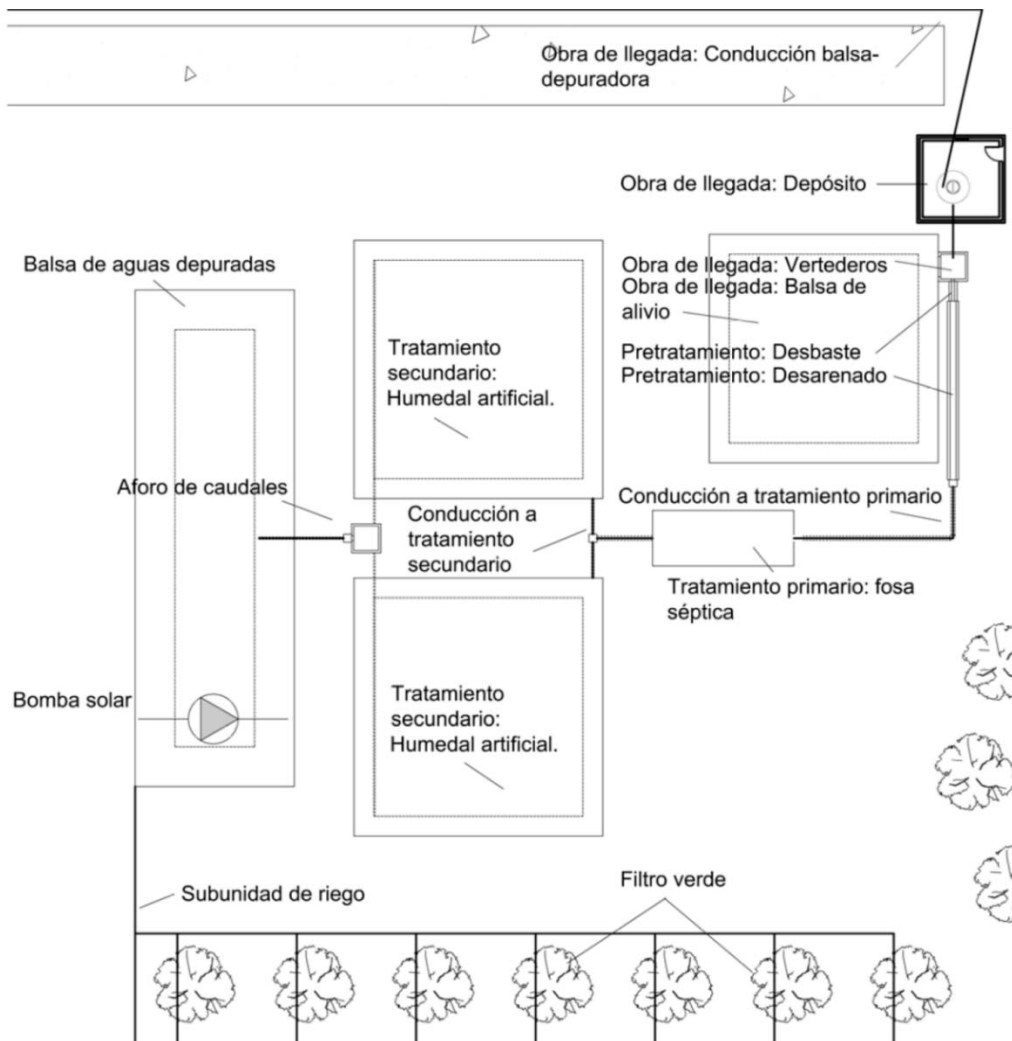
Planta simplificada del proyecto en la que se señalan las principales fases y los elementos relevantes la implementación, en la ingeniería del diseño. Fuente: elaboración propia.
